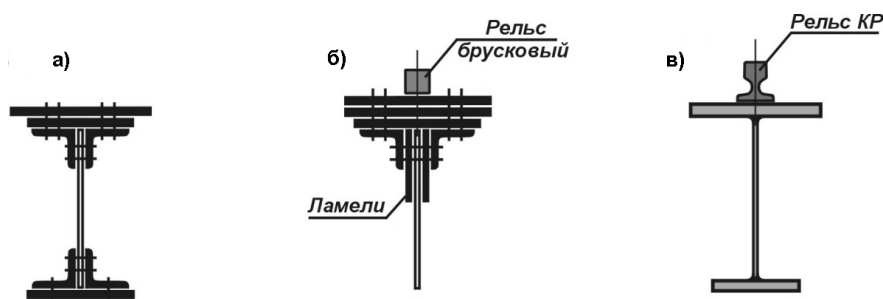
Типы сечений подкрановых балок: а – сечение клепанной балки; б – верхняя зона стенки балки с ламелями; в – сечение сварной подкрановой балки
